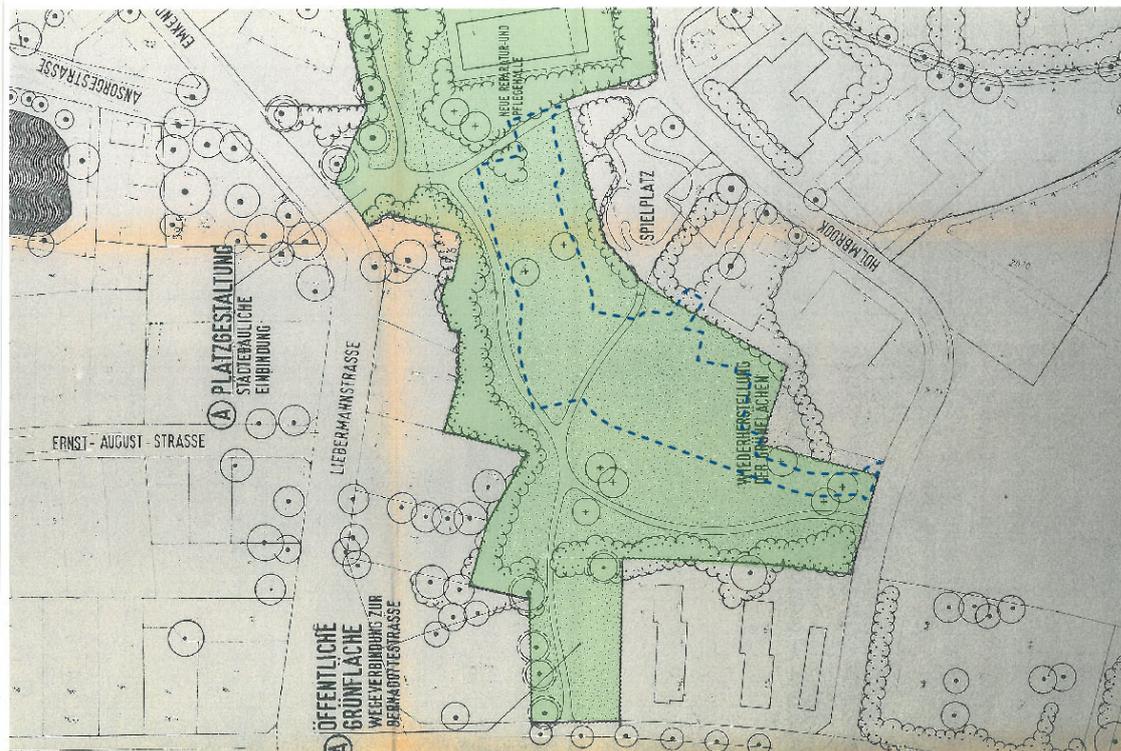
Planungskarte Landschaftspflegerischer Begleitplan 4. Elbtunnelröhre, Ausschnitt,
